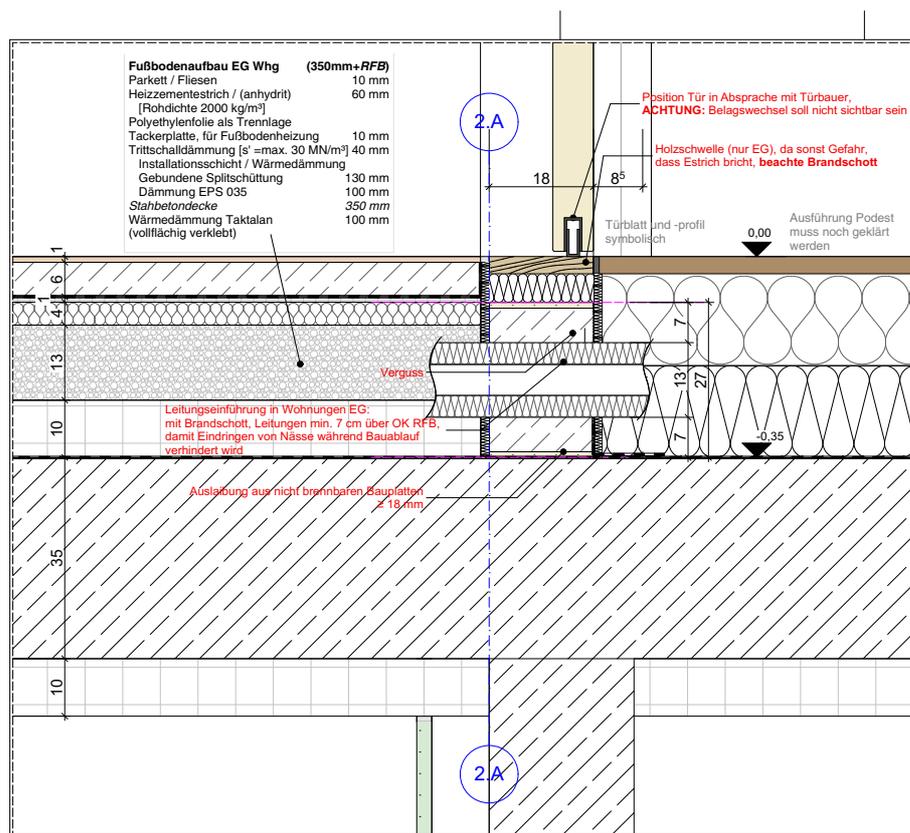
Plan 221-05-241-2 Wohnungstür Atriumwand Schnitt EG
